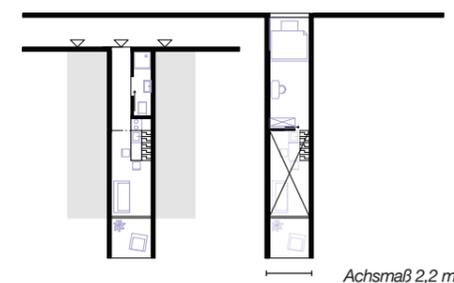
Wohnangebot A Grundrissvarianten mit versch. Achsmaßen (Raumbreite), ohne Maßstab
